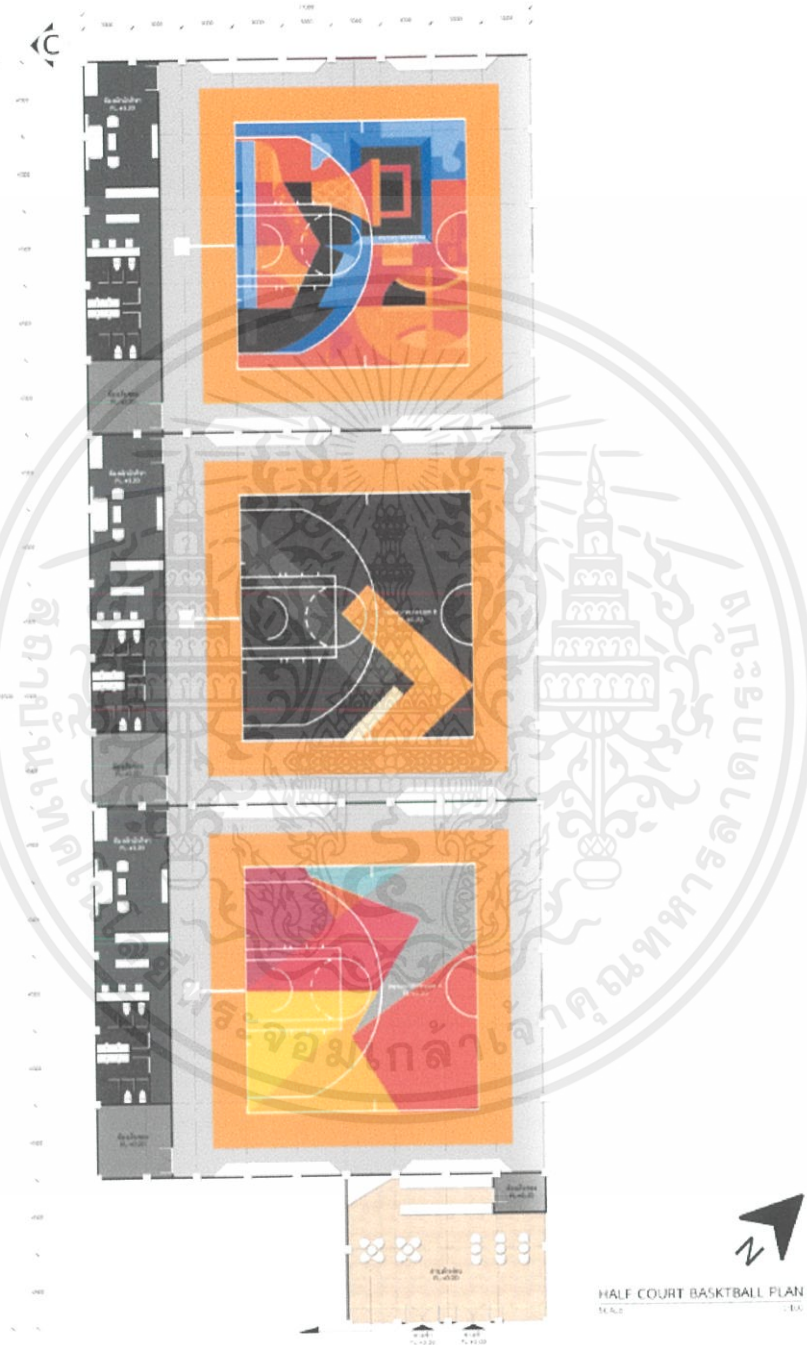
แสดงผังเฟอร์นิเจอร์ 3rd FLOOR
